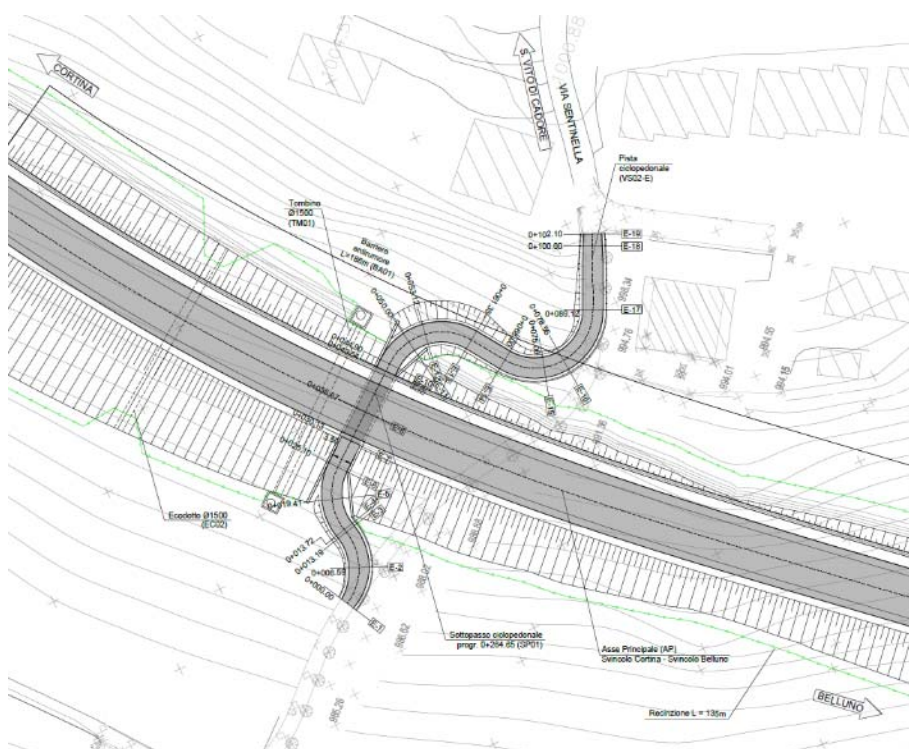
Stralcio Planimetrico – Pista Ciclopedonale
